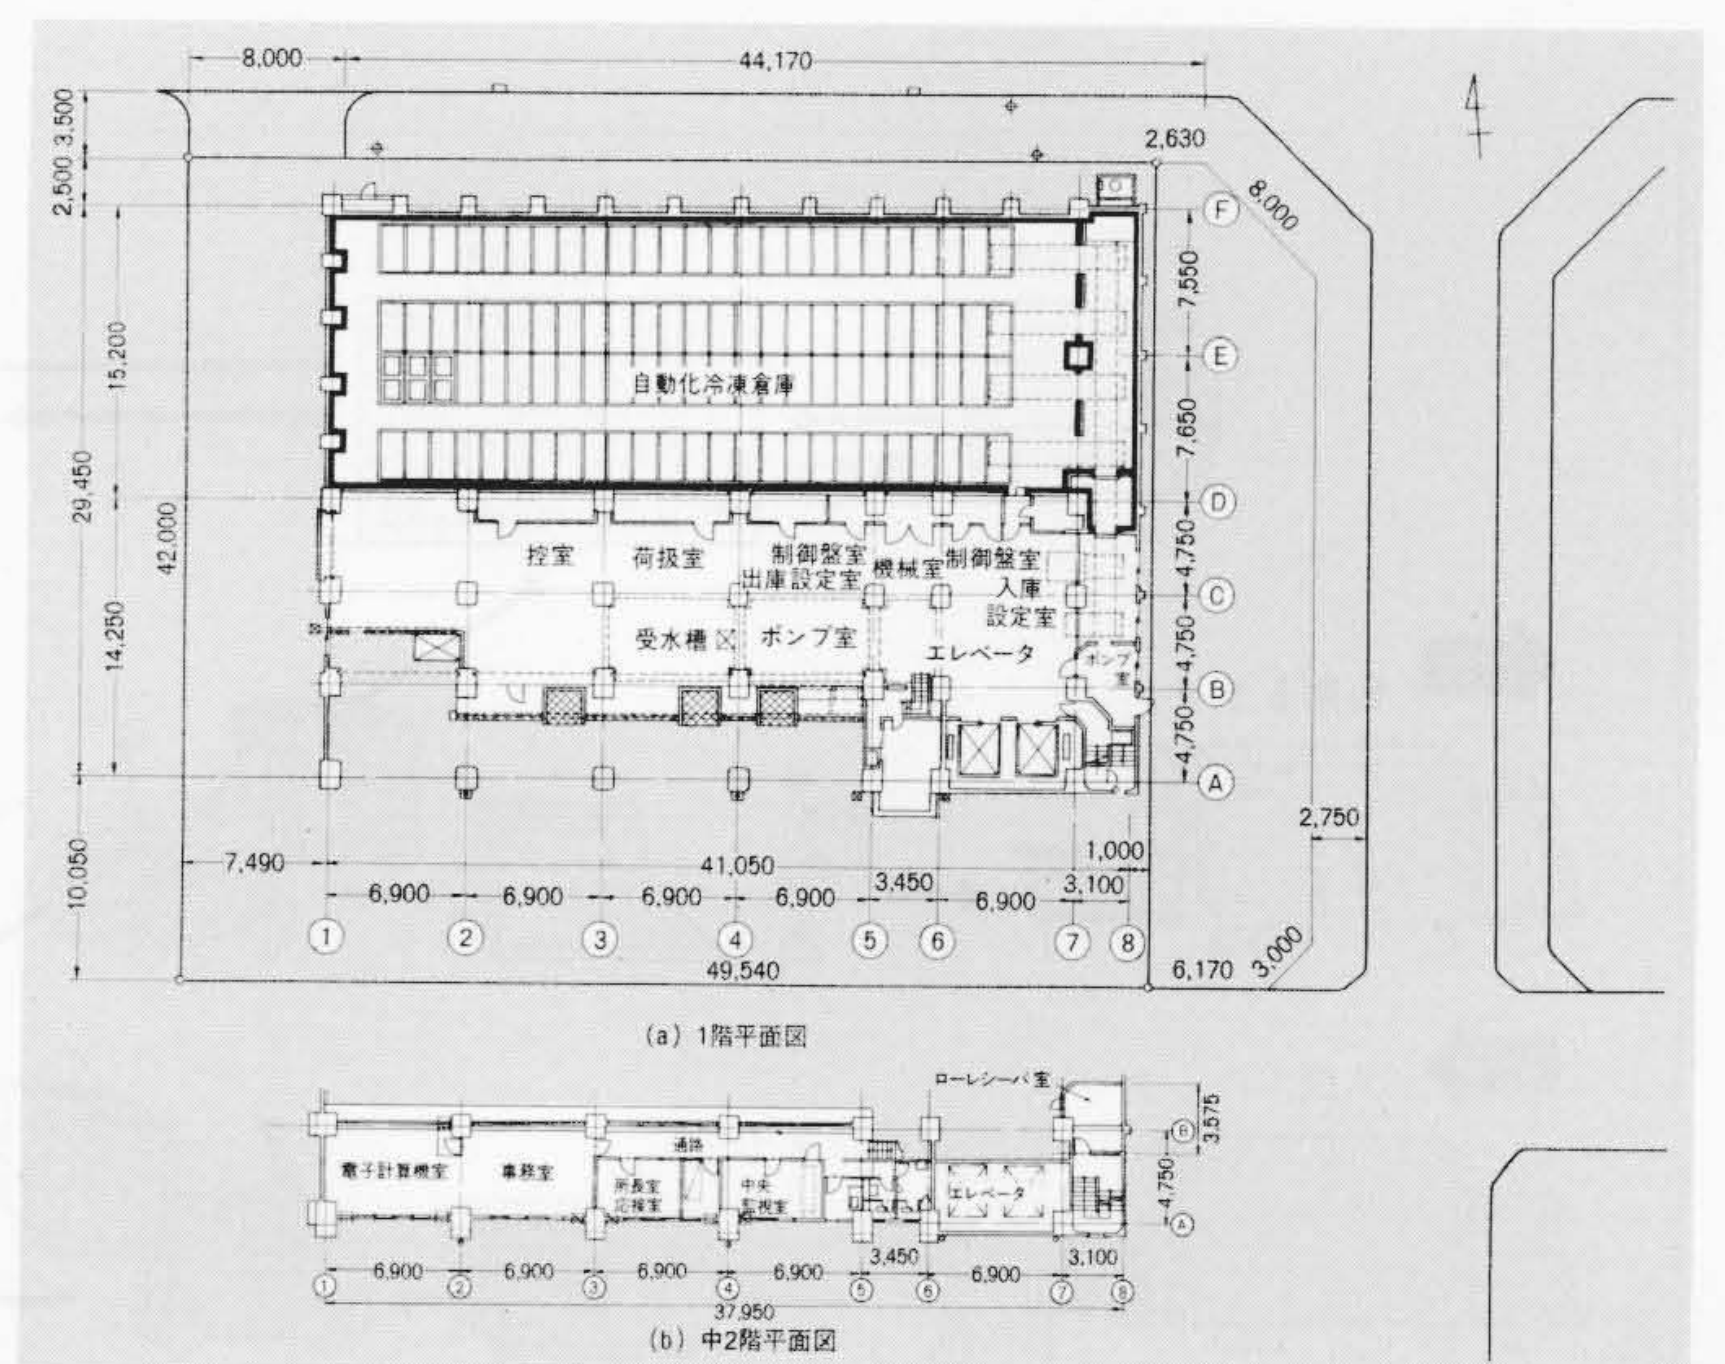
1階平面図 中央冷凍株式会社納入自動化冷凍倉庫平面を示す。
